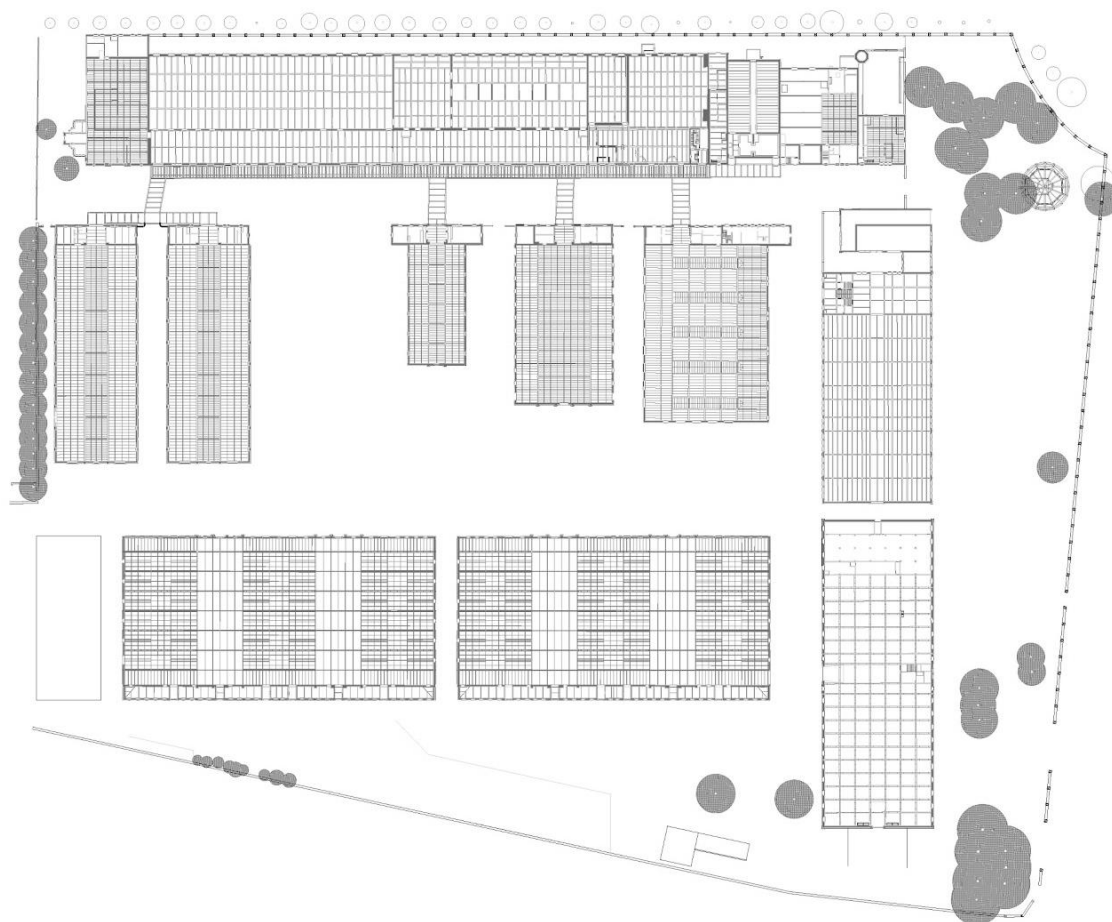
Matadero Madrid, Implantação do setor sul do conjunto
